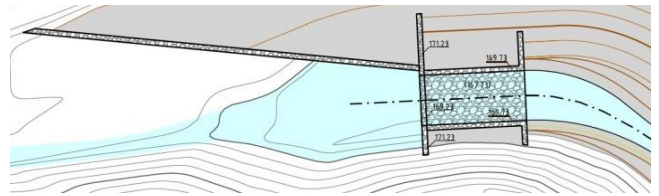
Planta da obra de ligação da Ribeira de Levadoiro ao canal 1.
